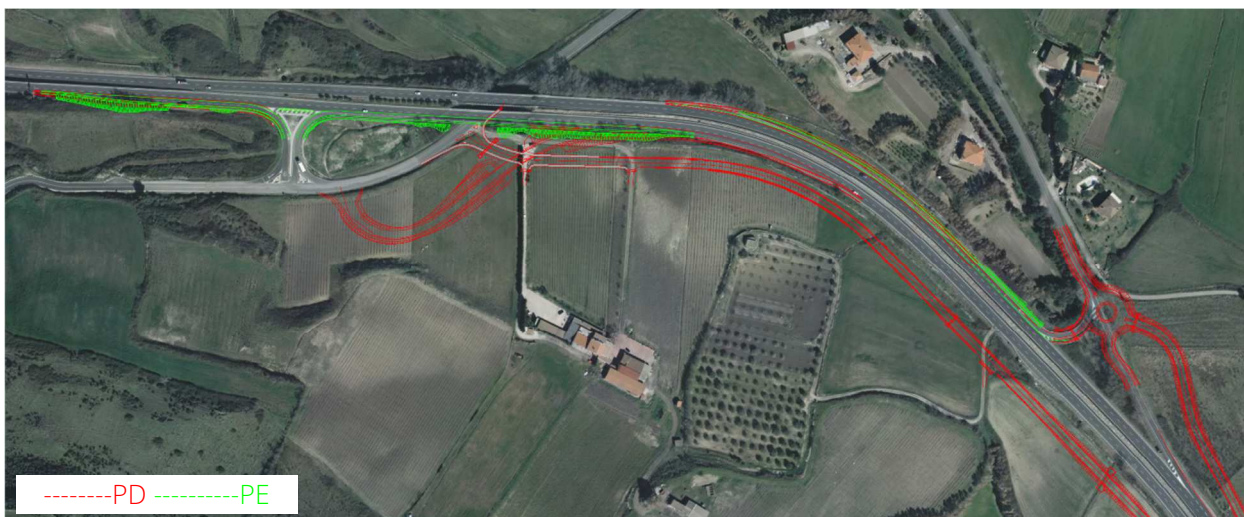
Sovrapposizione PD/PE – Svincolo di Florinas
